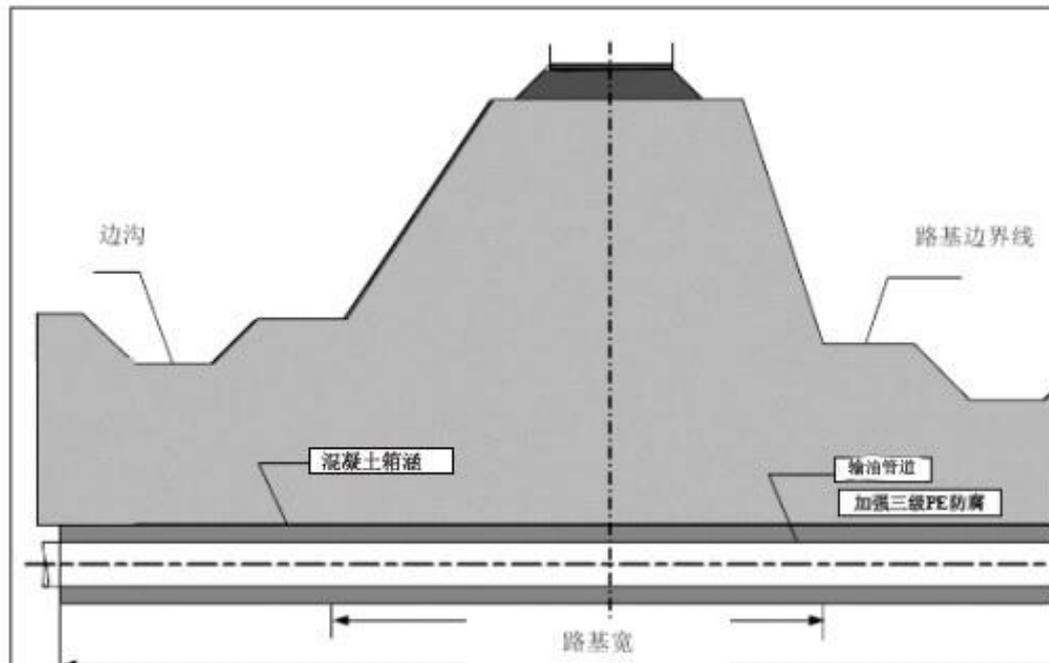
铁路穿越施工方式断面示意图
